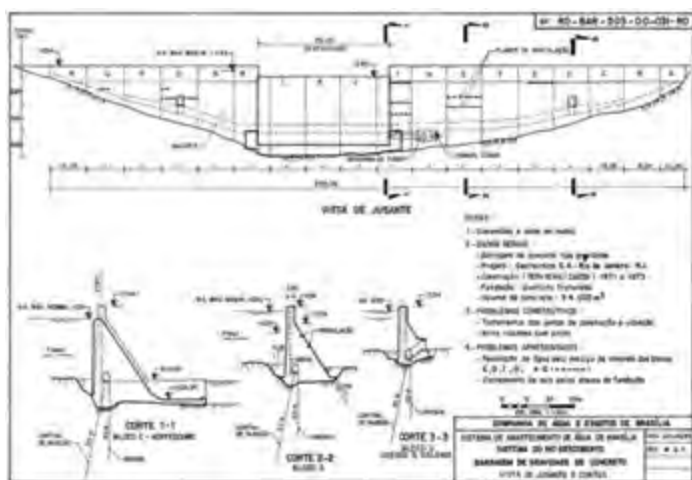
Barragem Rio Descoberto – Vista de jusante e cortes
